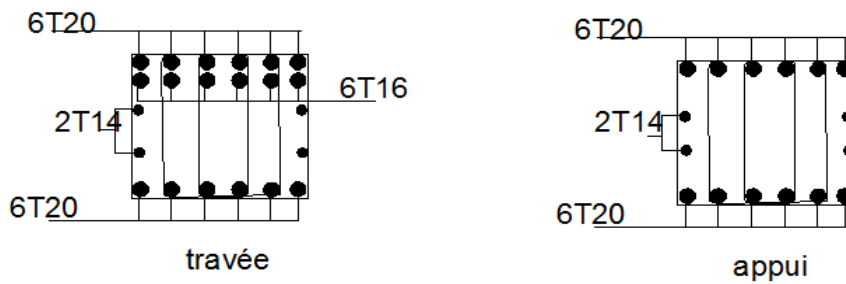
Ferrailage du panneau du radier sens x-x.
